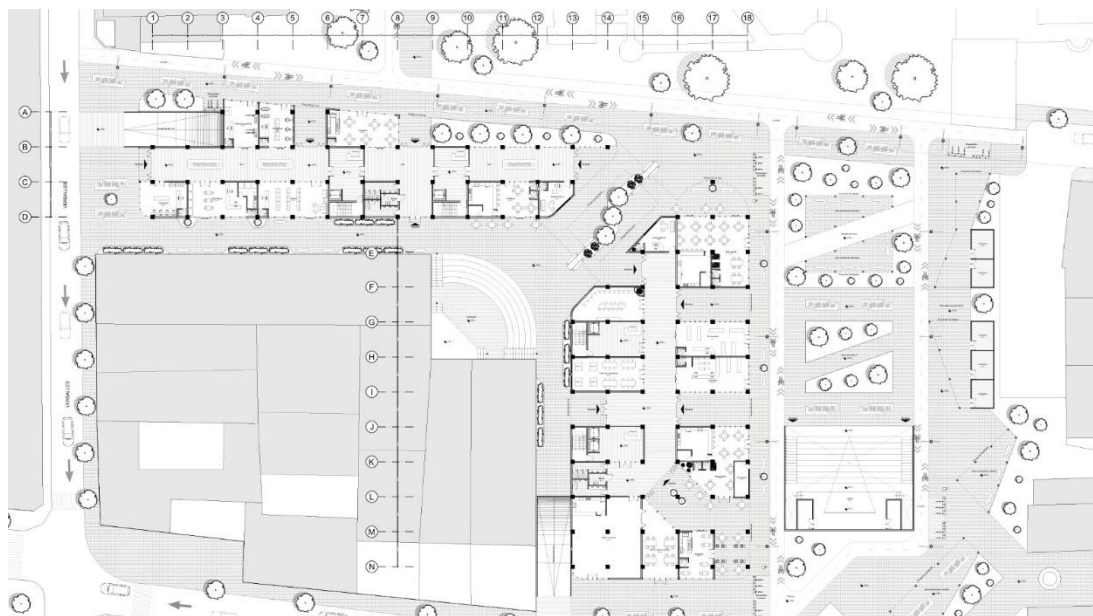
Planta Baja del proyecto: Elaboración propia
